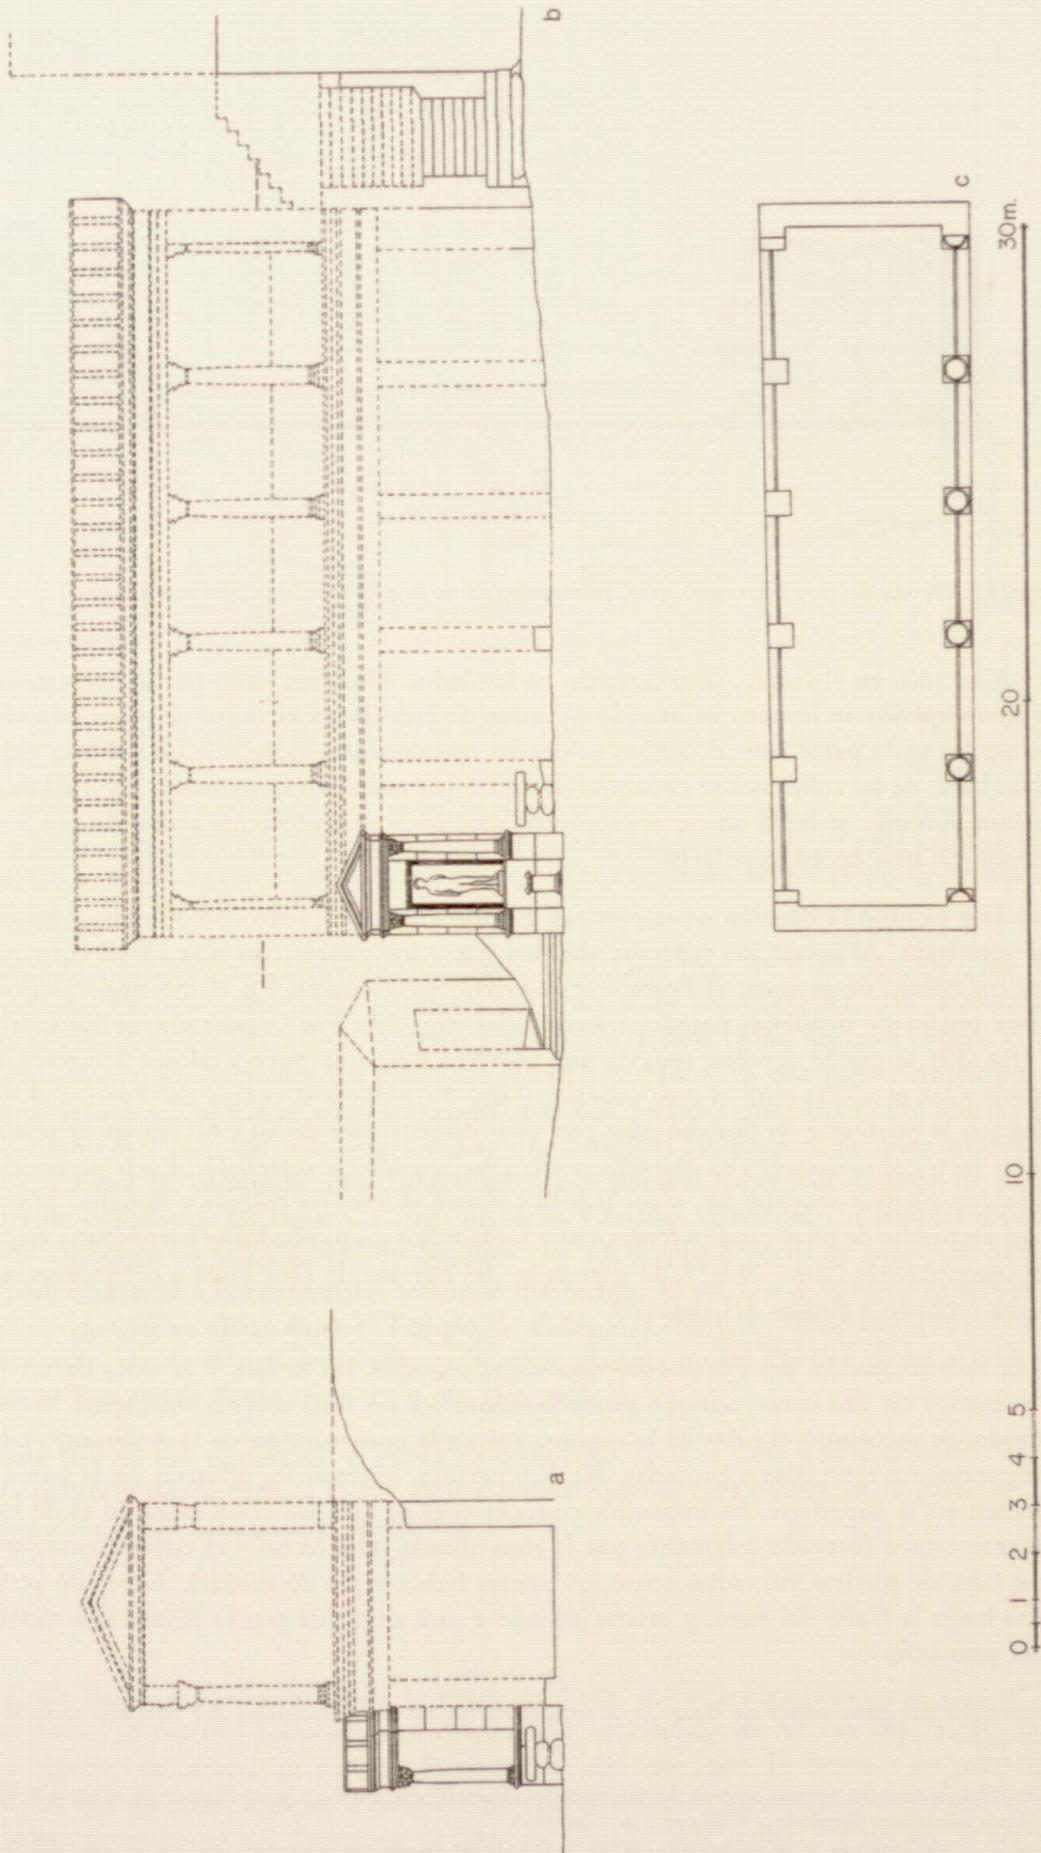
Pórtico de Dos Pisos, reconstrucción. a) corte, b) vista, c) planta del piso superior.
